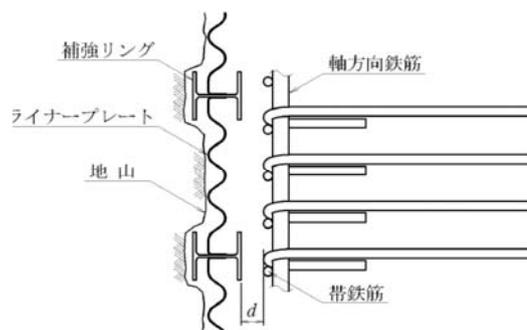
鉄筋の最小かぶり（道示IV編, 図-14.9.1）
